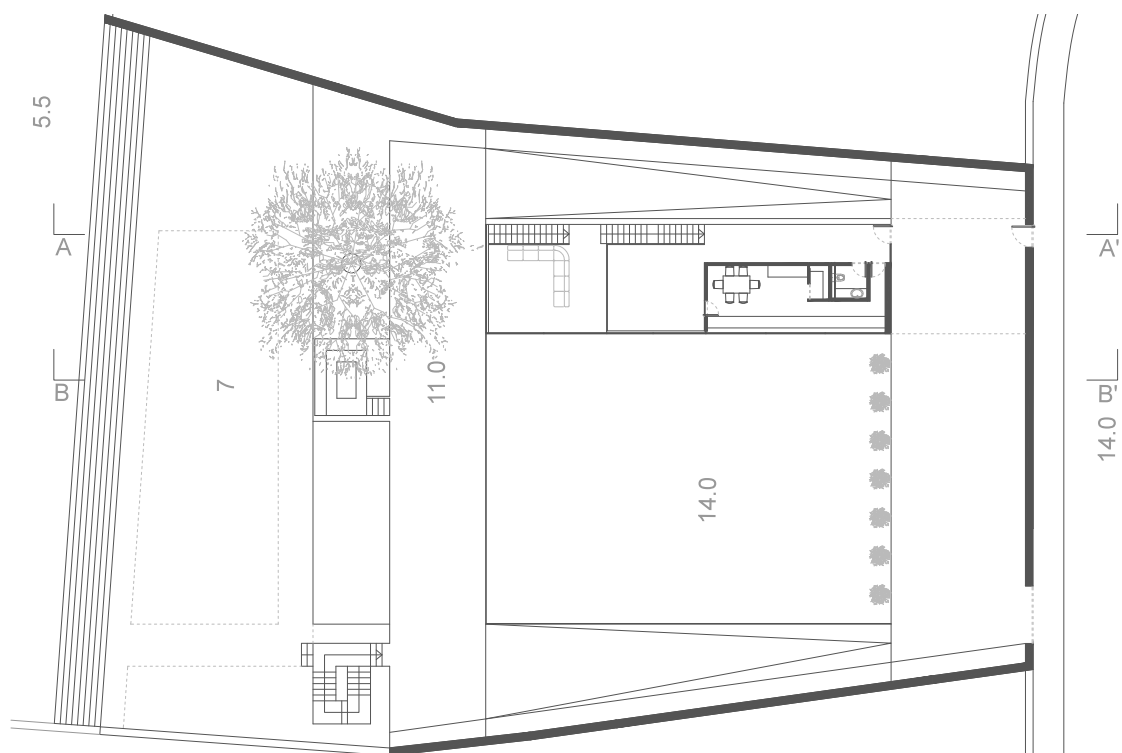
e 36 - Planta piso 0 e Planta piso -1.
